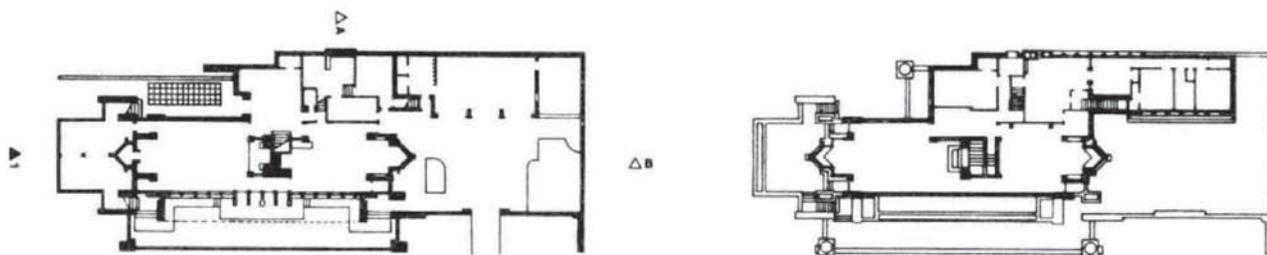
Robie House – Plantas Baixas. Fonte: ZEVI, Bruno (1995).
